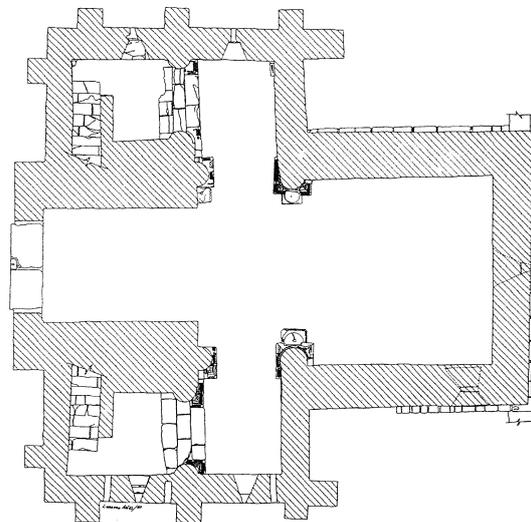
San Miguel de Liño. Planta. Estado actual.
